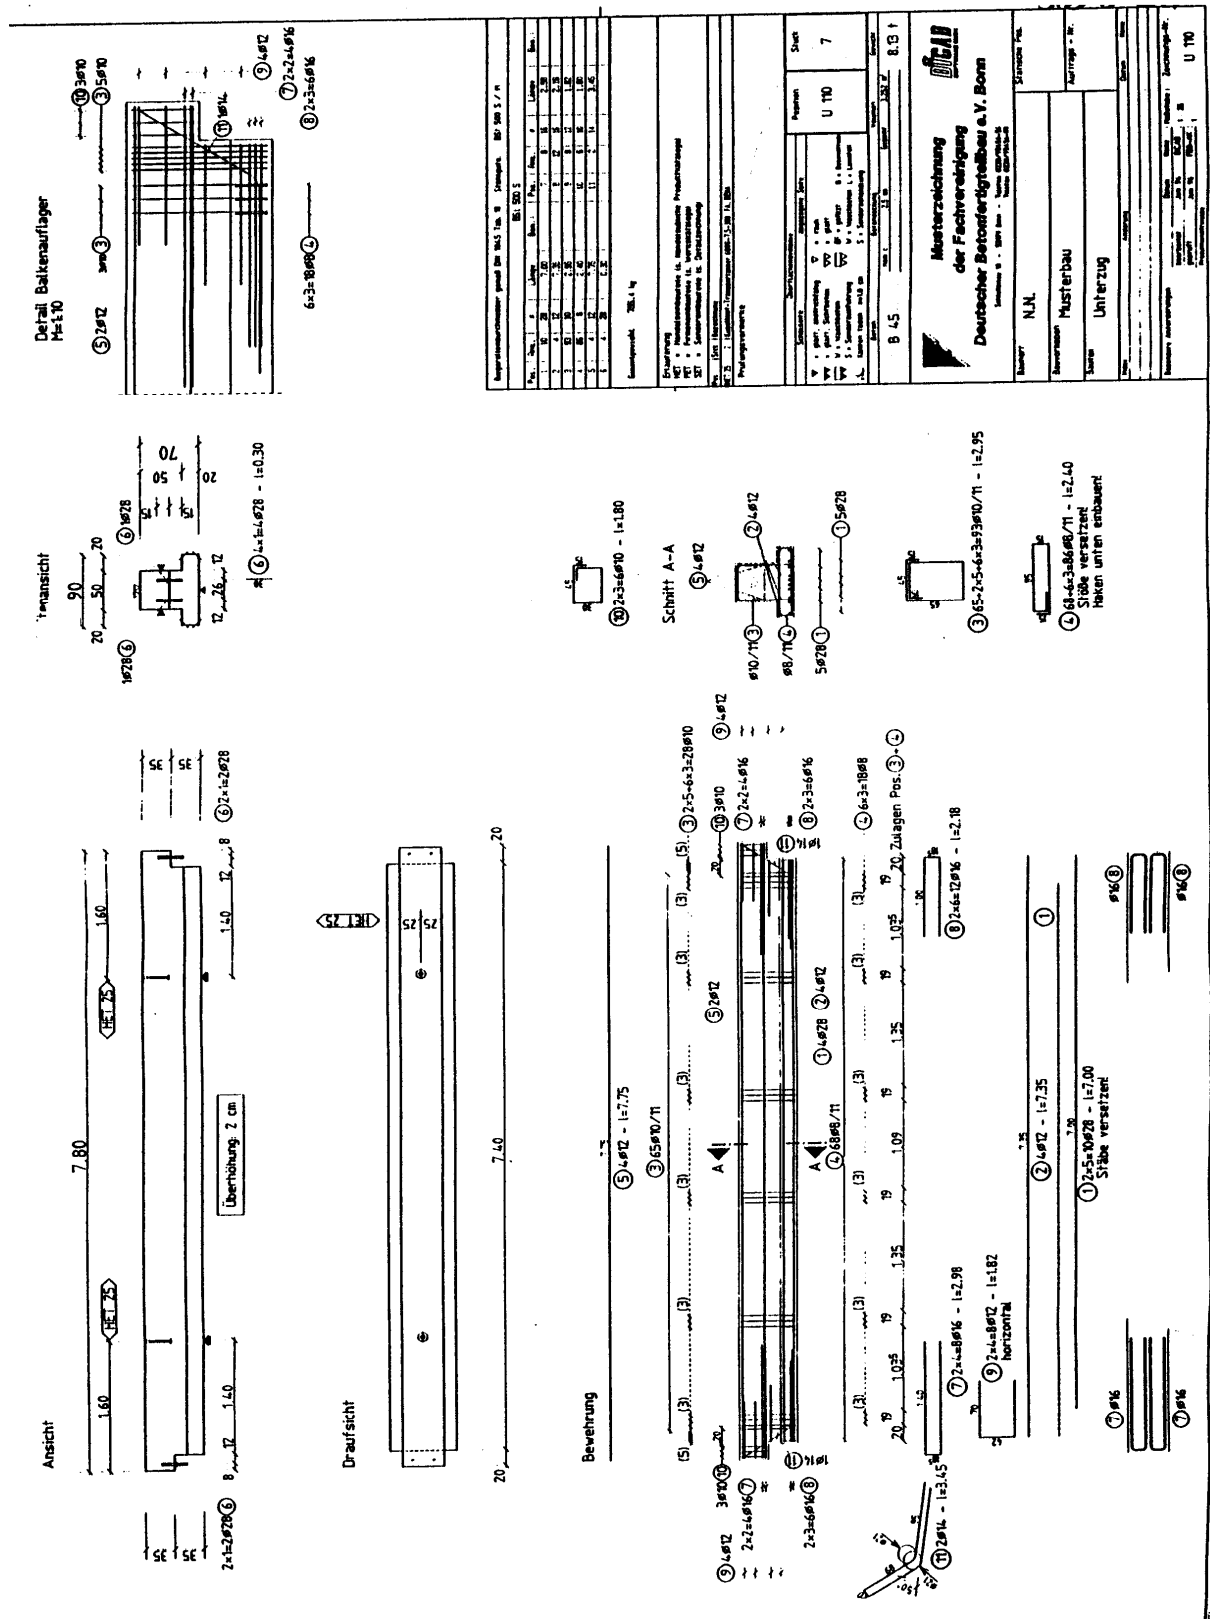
Schal- und Bewehrungsplan für ein Fertigteil
